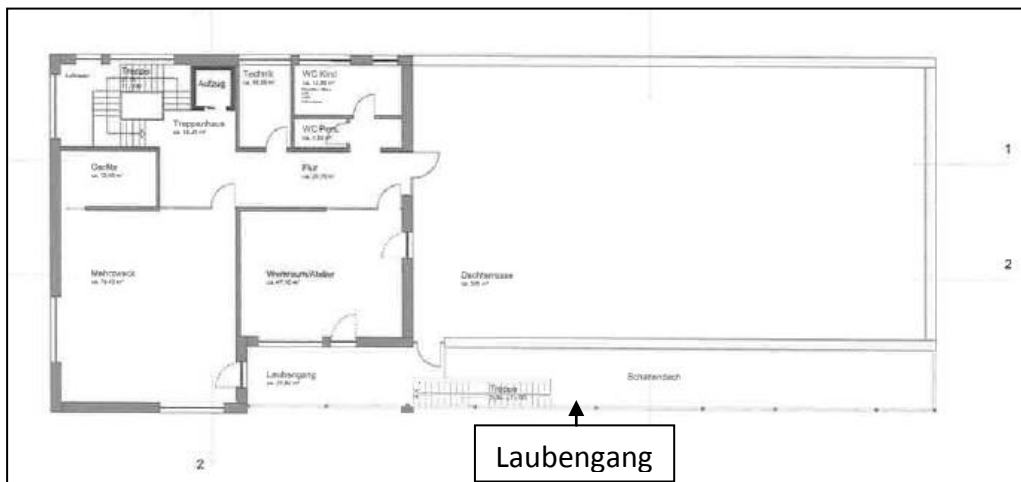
Grundriss geplante Kindertagesstätte (2. OG)
